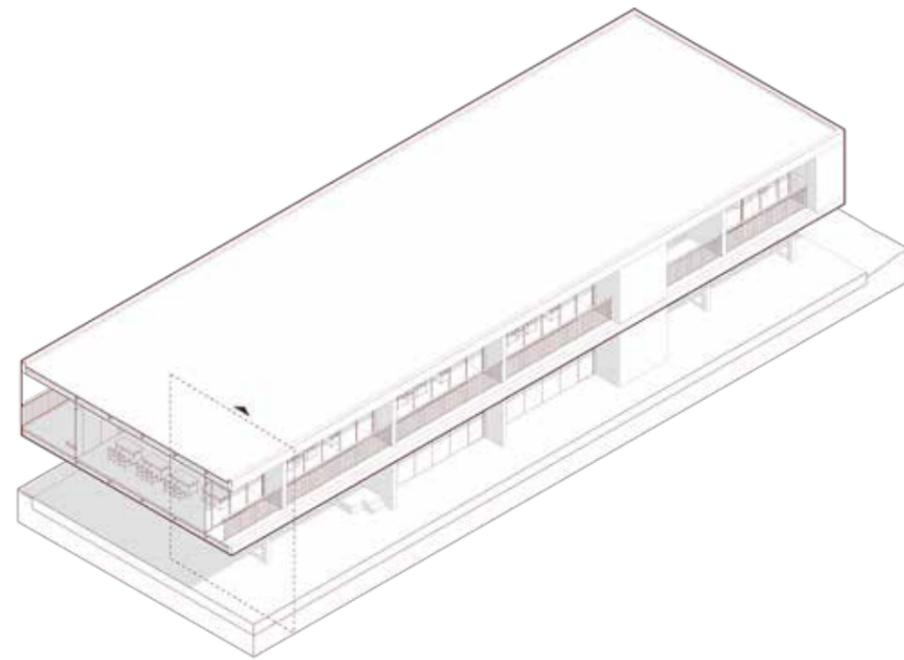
Axonometría completa detalle Fuente: Elaboración propia.
